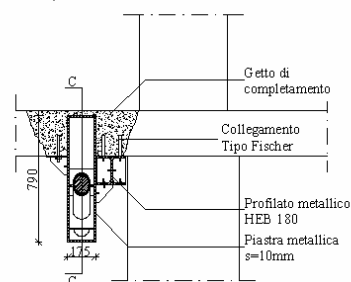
Connessione della trave di collegamento con i pilastri ed i solai interessati (particolare 1 e sezione A-A di Figura 19)
